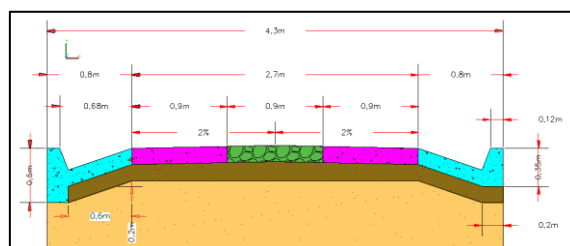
Sección final de placa huella construida entre abscisa K0+132 m y K0+060.
